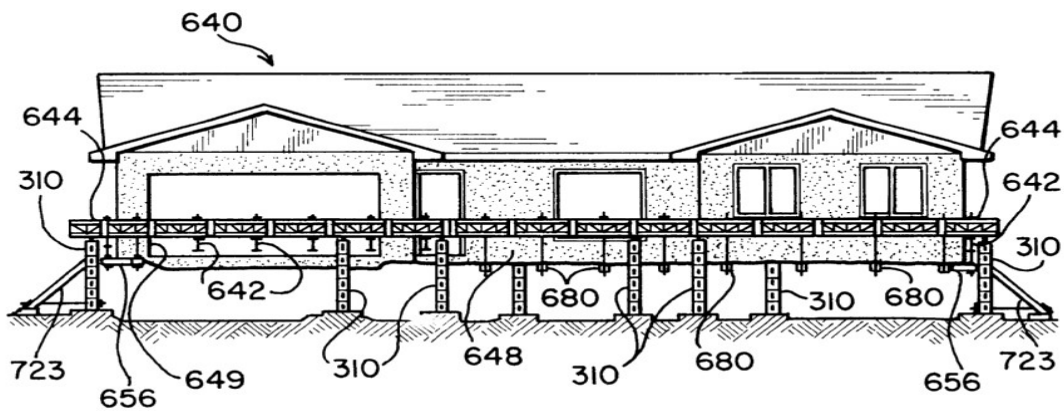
Method and apparatus for relocating a structure from a first elevation to a second elevation (Petter Vanderklaauw, 2002)
